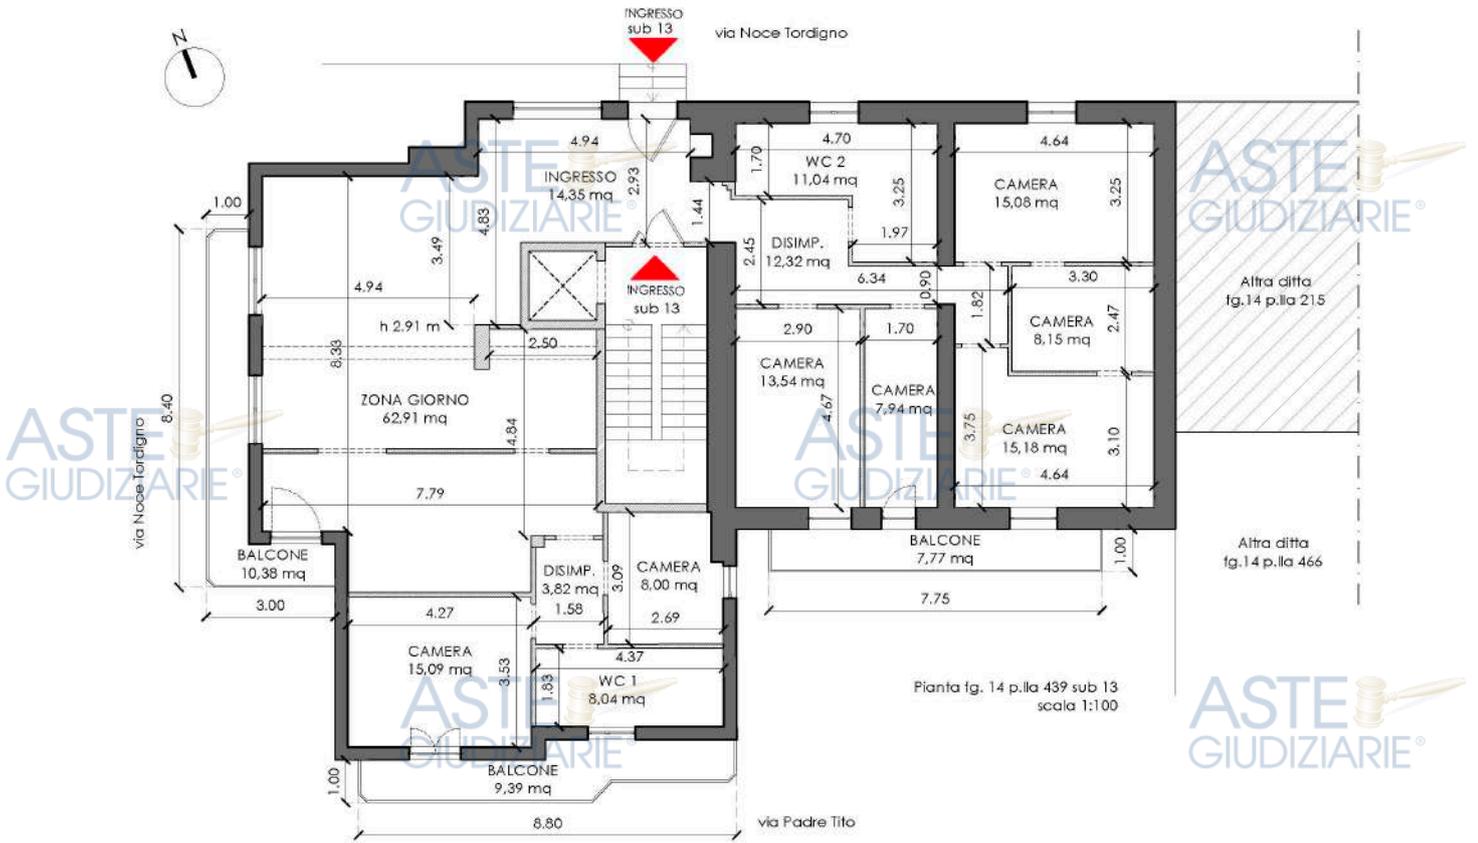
Rilievo Abitazione in corso di costruzione Lotto Quattro Stato di fatto \_ pianta piano primo (Allegato 6E)
